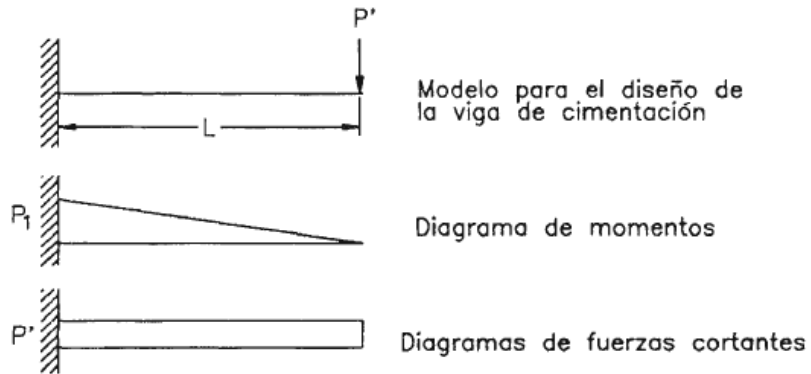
Modelo para el Diseño de las Zapatas Conectadas
